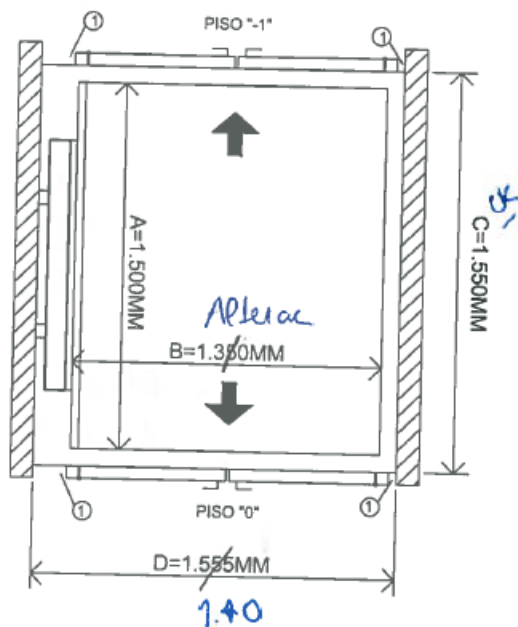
Medidas úteis em planta [AVicêncio B, 2017]
